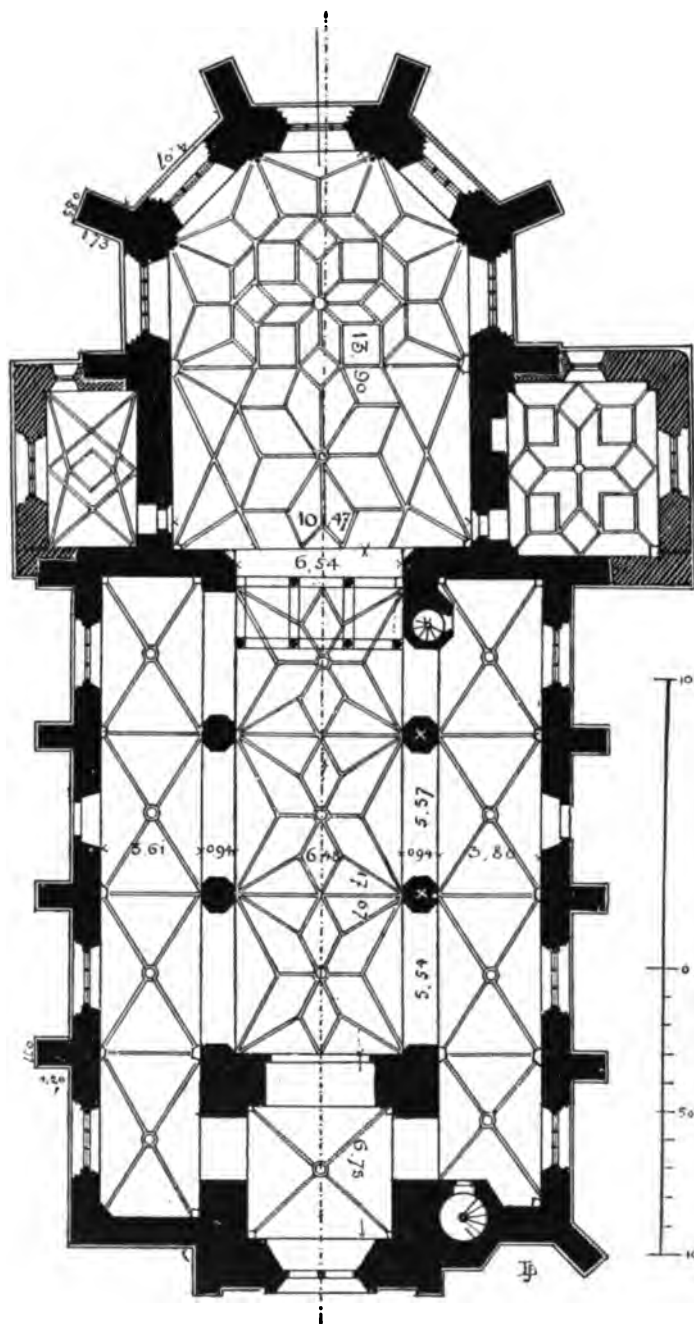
Kiedrich. Pfarrkirche. Grundriss.
